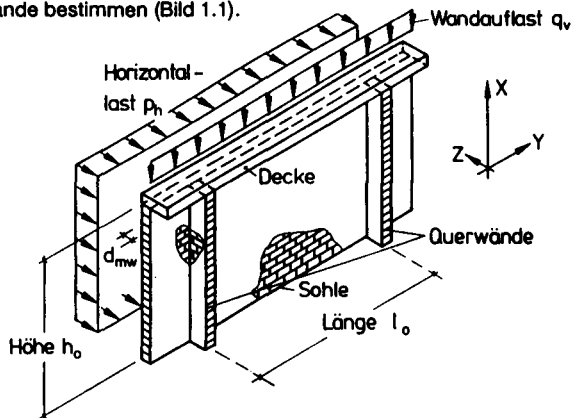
Kombinierte Beanspruchung von Mauerwerkswänden durch vertikale Auflasten und Horizontaldruck
